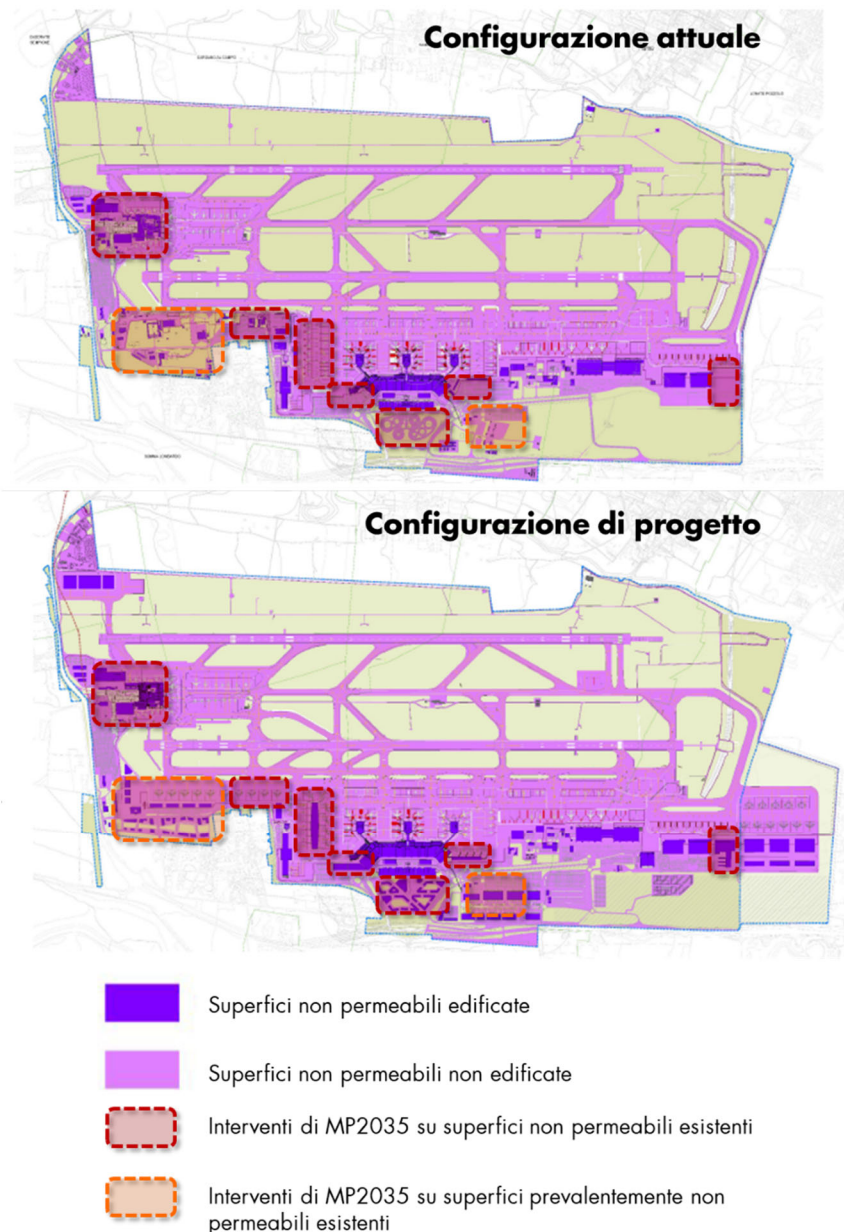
Localizzazione delle opere di MP2035 rispetto alle superfici attualmente impermeabilizzate
